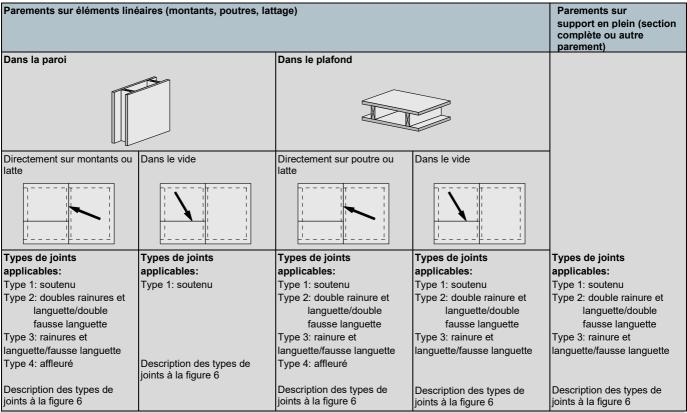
types de joints applicables aux matériaux en bois plats en fonction de la situation de montage. Pour les panneaux coupe-feu, les dispositions du chapitre 2.4 s'appliquent.
